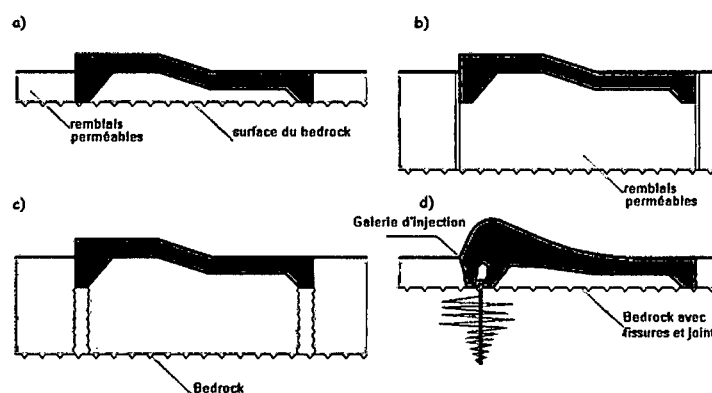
Barrière étanche dans la fondation du barrage.
